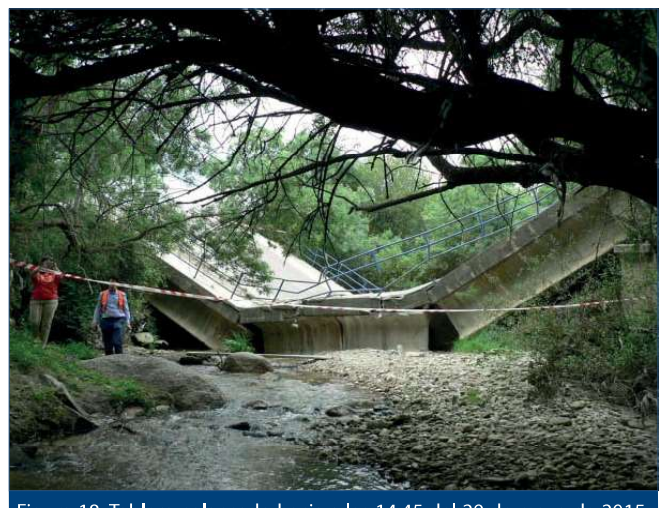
Tablero colapsado hacia a las 14:45 del 29 de mayo de 2015. Vista desde lado izquierdo
